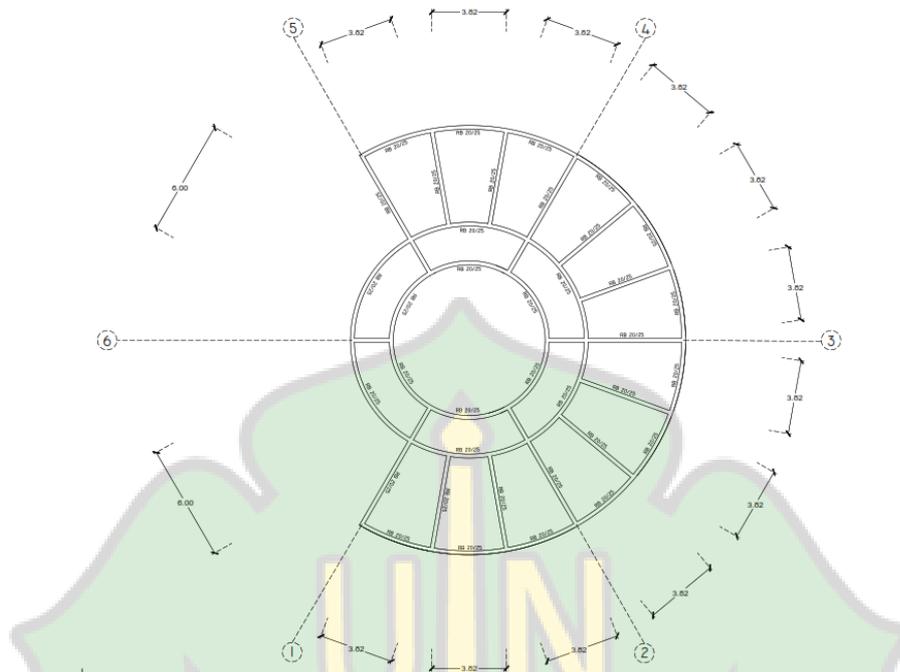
Denah Plat Lantai 3 Lobby dan Pengelola
